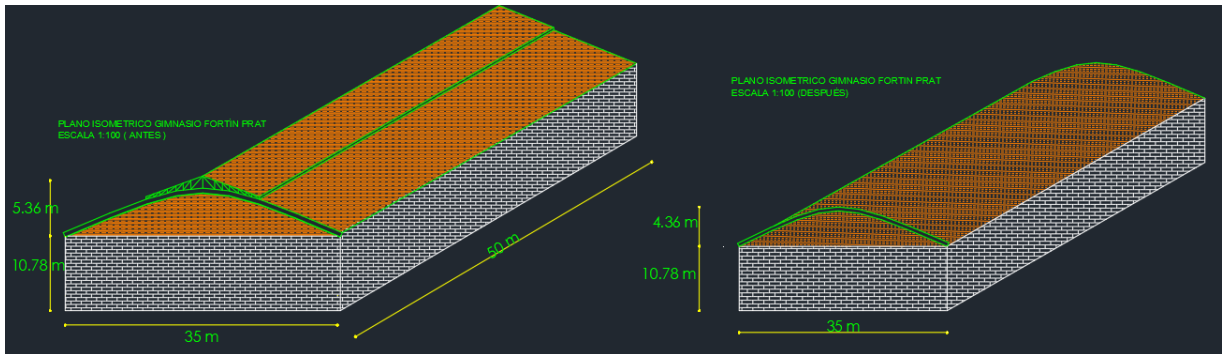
Detalle planos isométrico, cambio de cubierta
